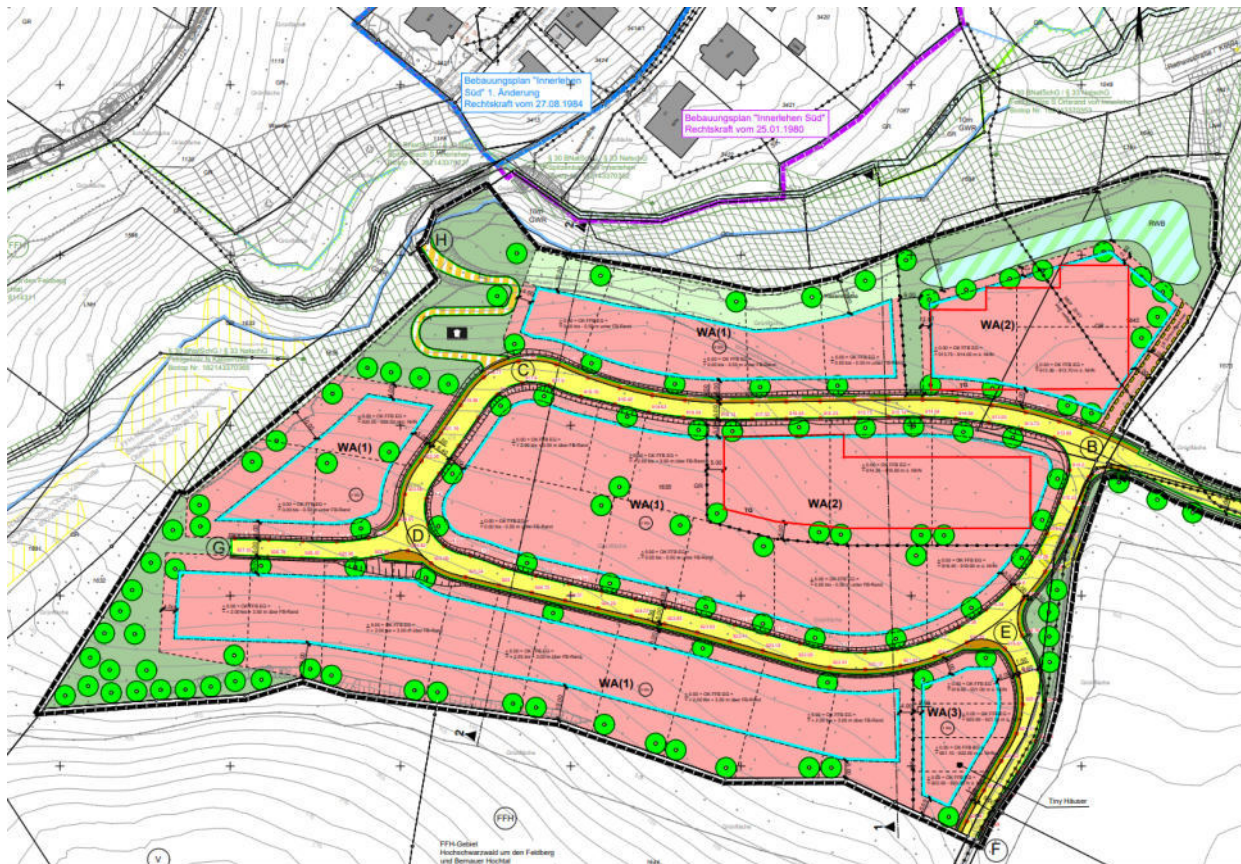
B-Plangebiet „Auf dem Buck“ (Planstand vom 14.05.2024), westlicher Teil
